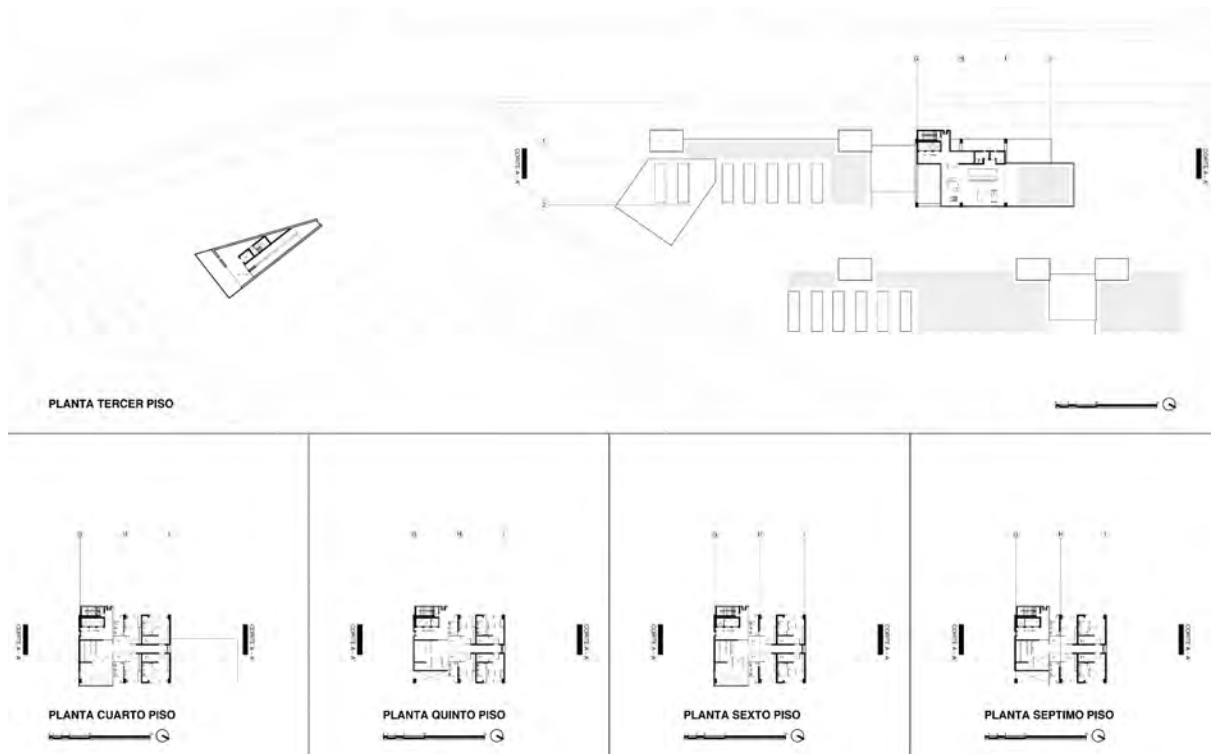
Plantas torre de vivienda. Ilustración realizada por el autor
